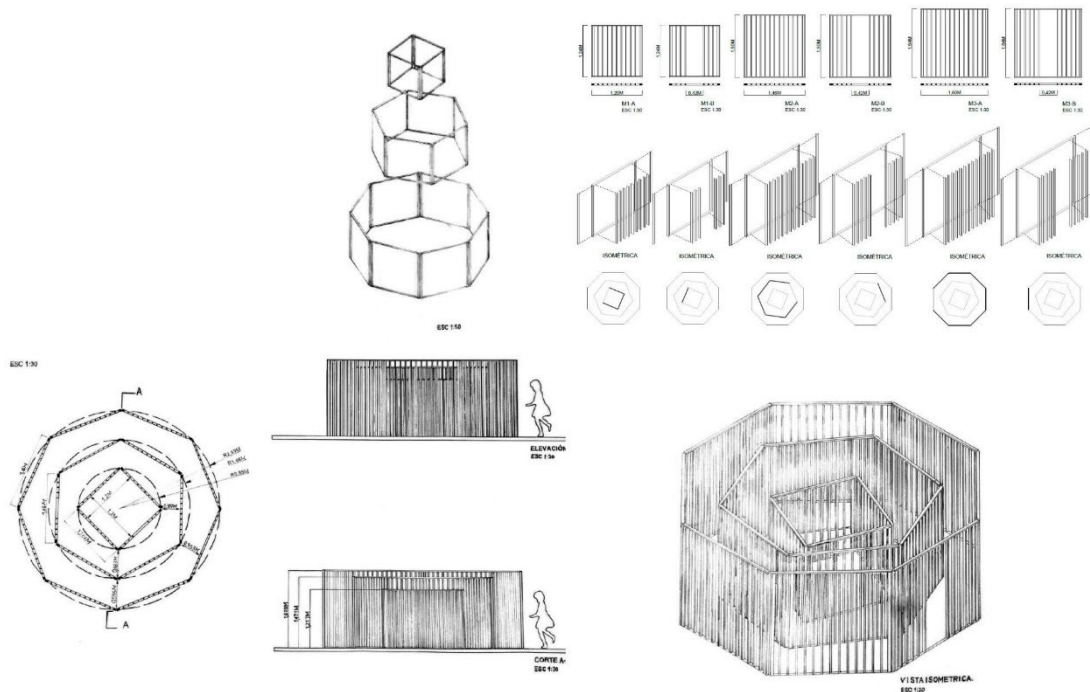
Planimetría de “Morada”. Fuente: Taller de Proyecto I, (2025)
